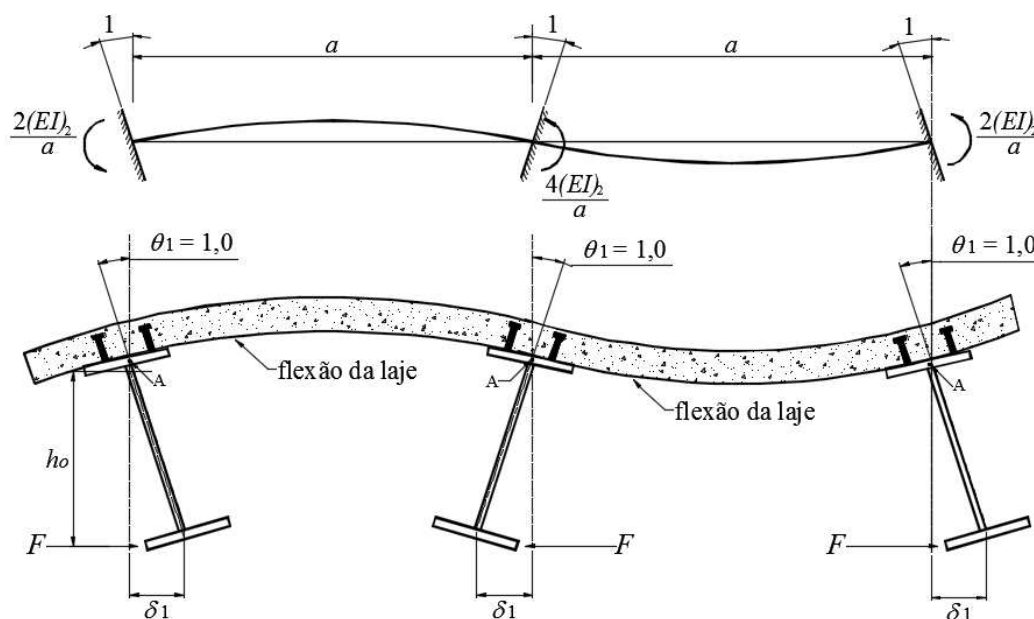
Rigidez à flexão da laje fissurada (CALENZANI, 2008).
